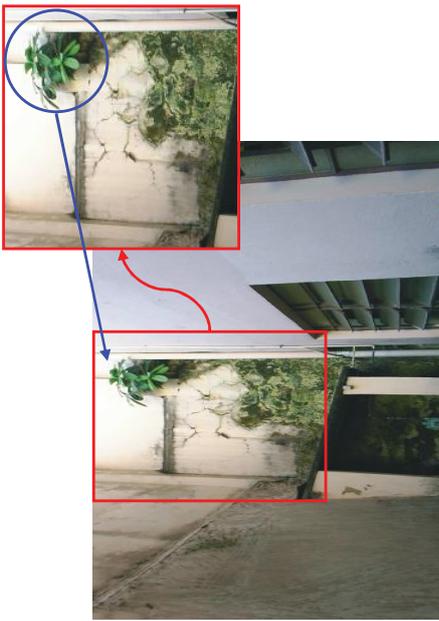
Infiltração nos muros de divisa com edificações vizinhas.
